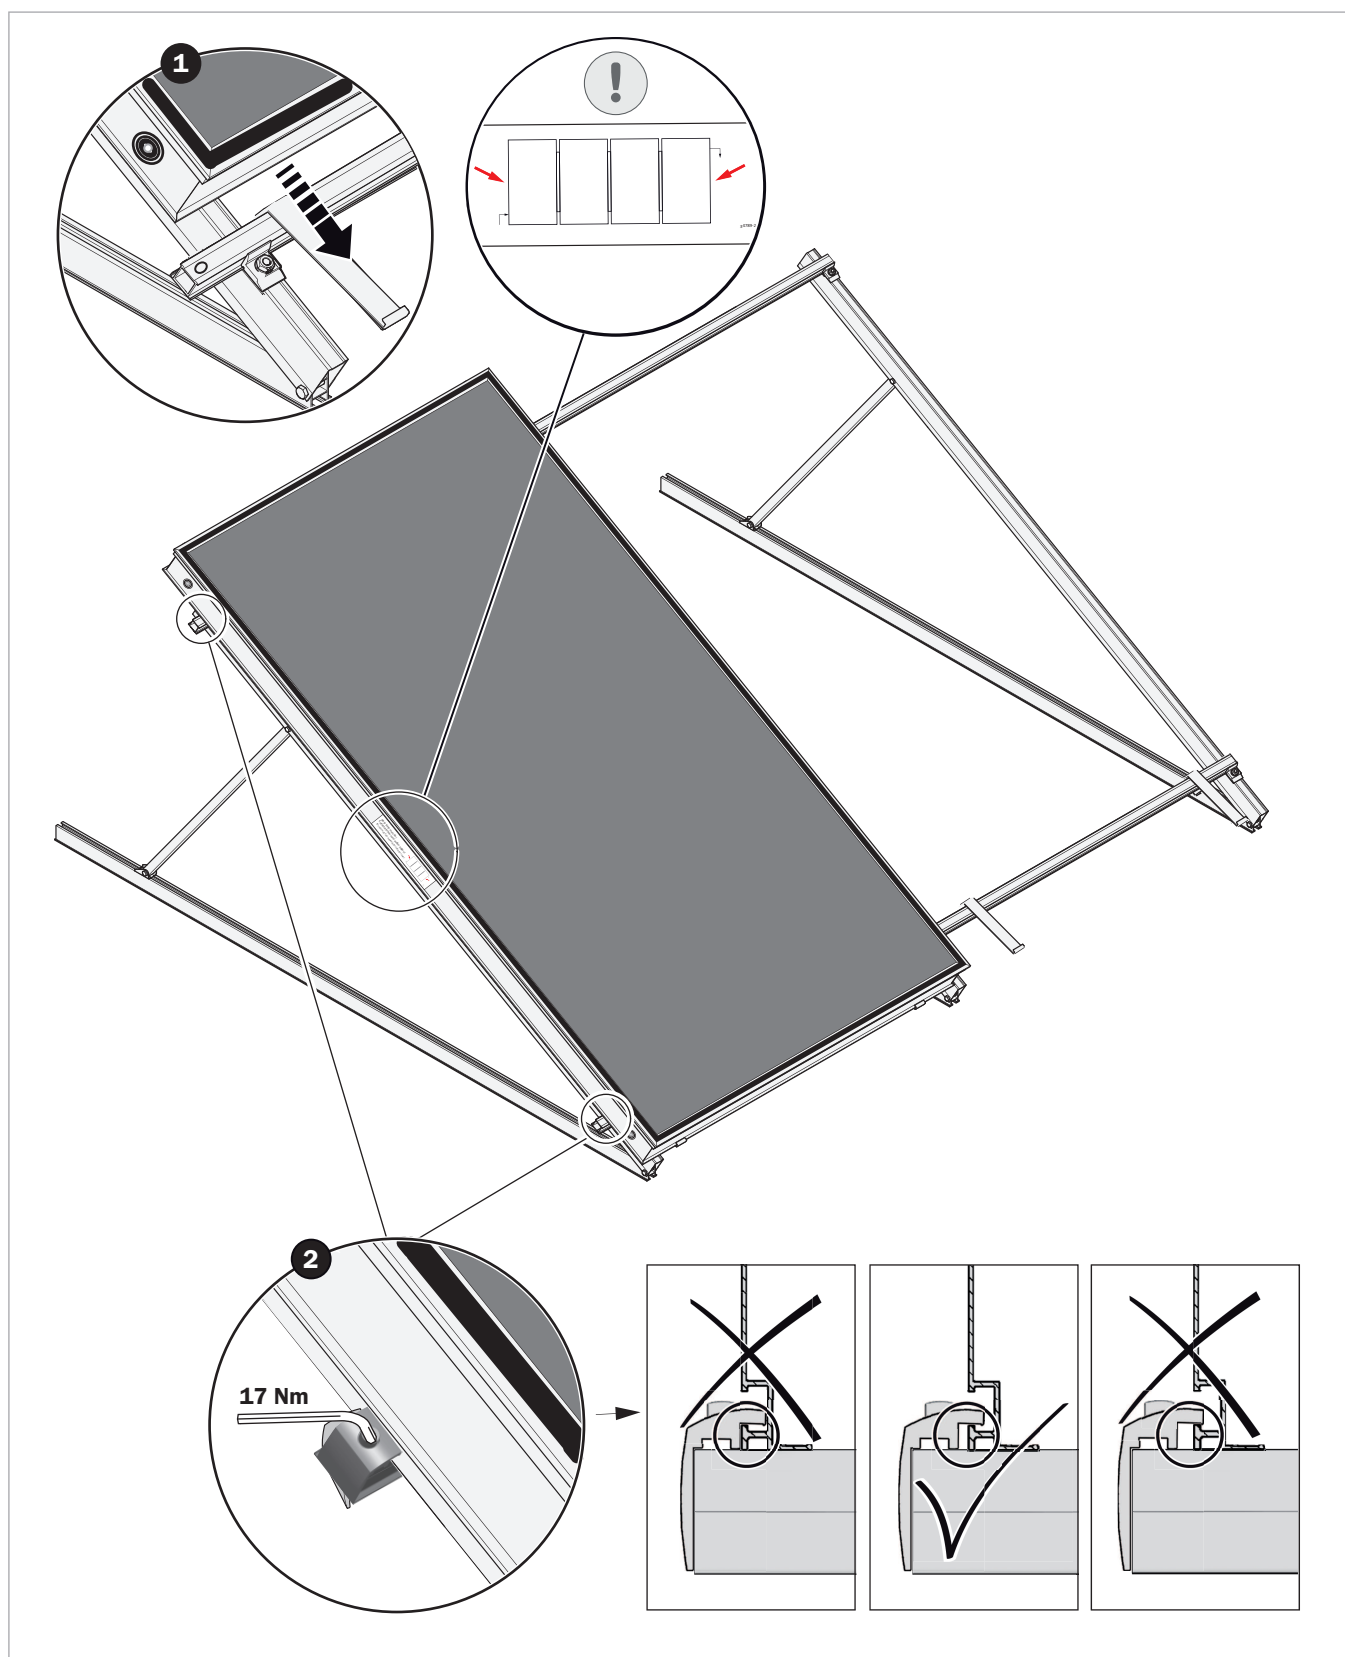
Fijación de un colector sobre los soportes para tejado plano
